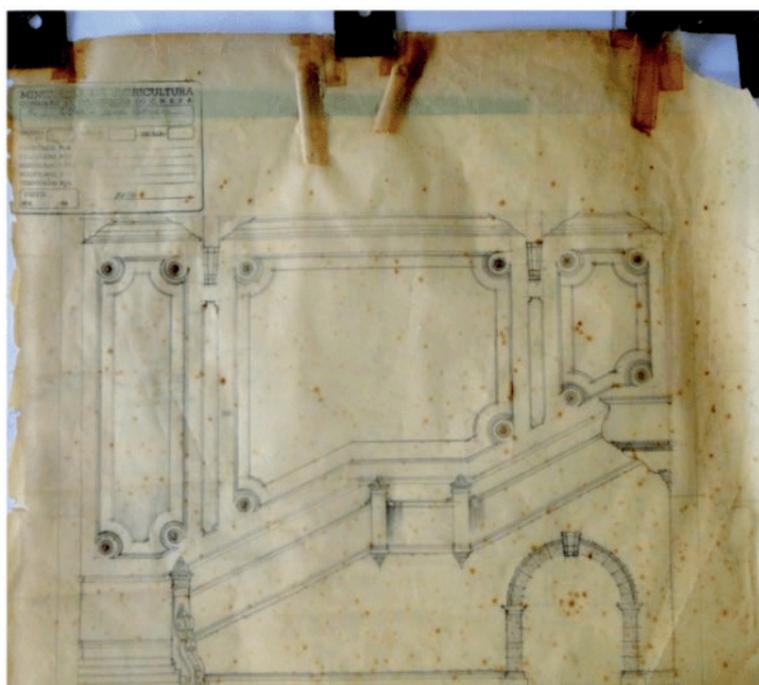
Desenhos de detalhes construtivos do Pavilhão Central da UFRRJ, de autoria de E. P. Sigaud, em técnica mista, grafite e nanquim sobre papel vegetal. Foto: Jéssica, jun/2014 – acervo da pesquisa.
